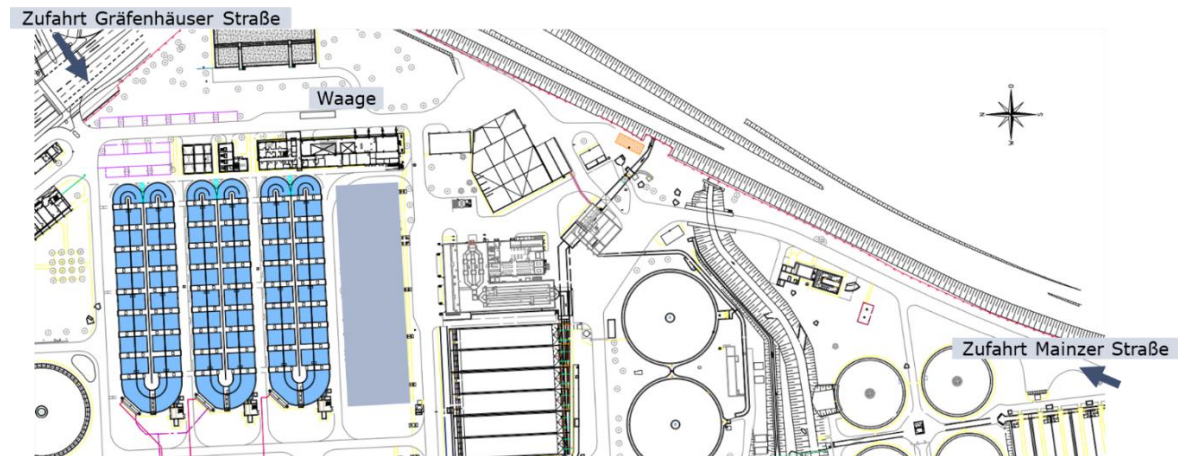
Lageplan des ZKW mit möglichem Baufeld für die Klärschlammbehandlung
